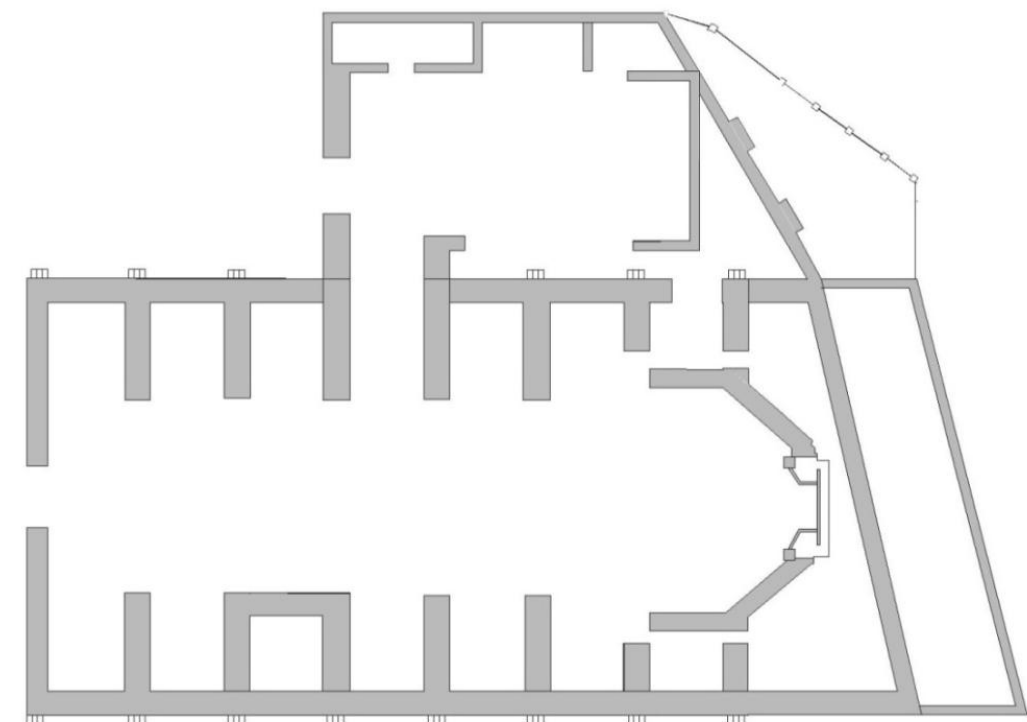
Imagen planta año 1715. Fuente: (propia).
